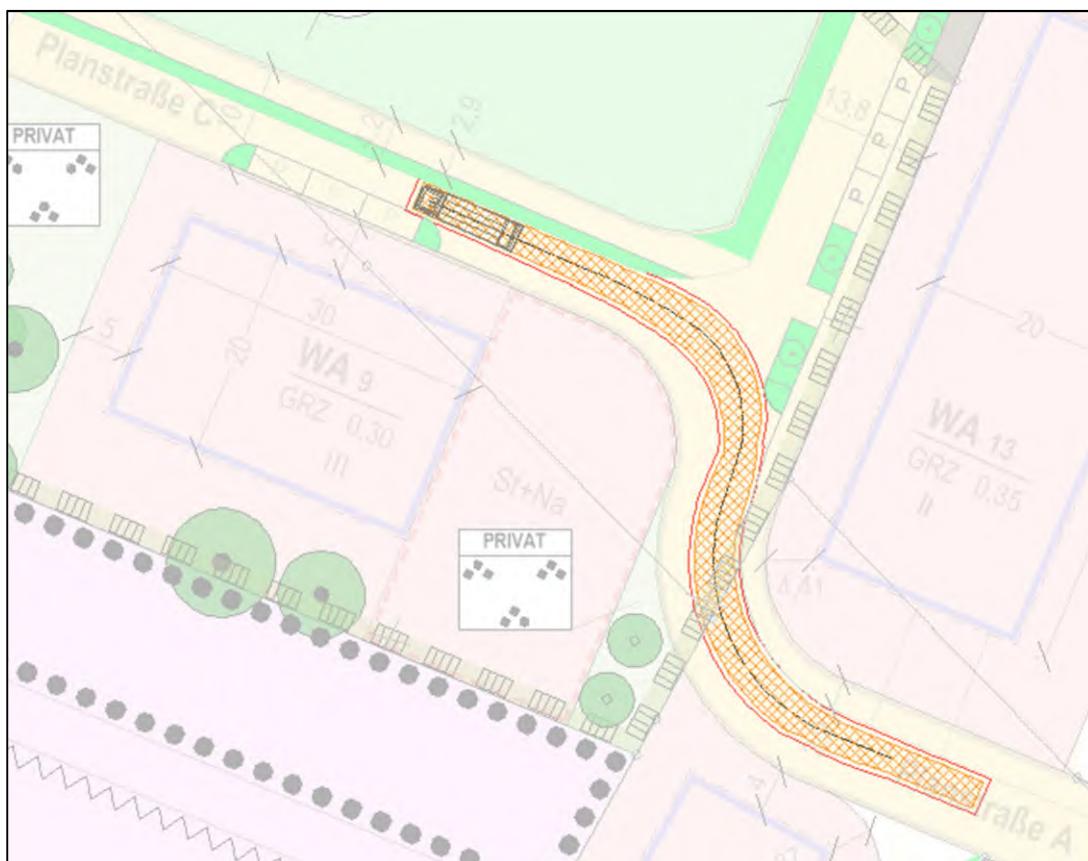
Schleppkurve Planstraße A nach Planstraße C (Müllfahrzeug)
